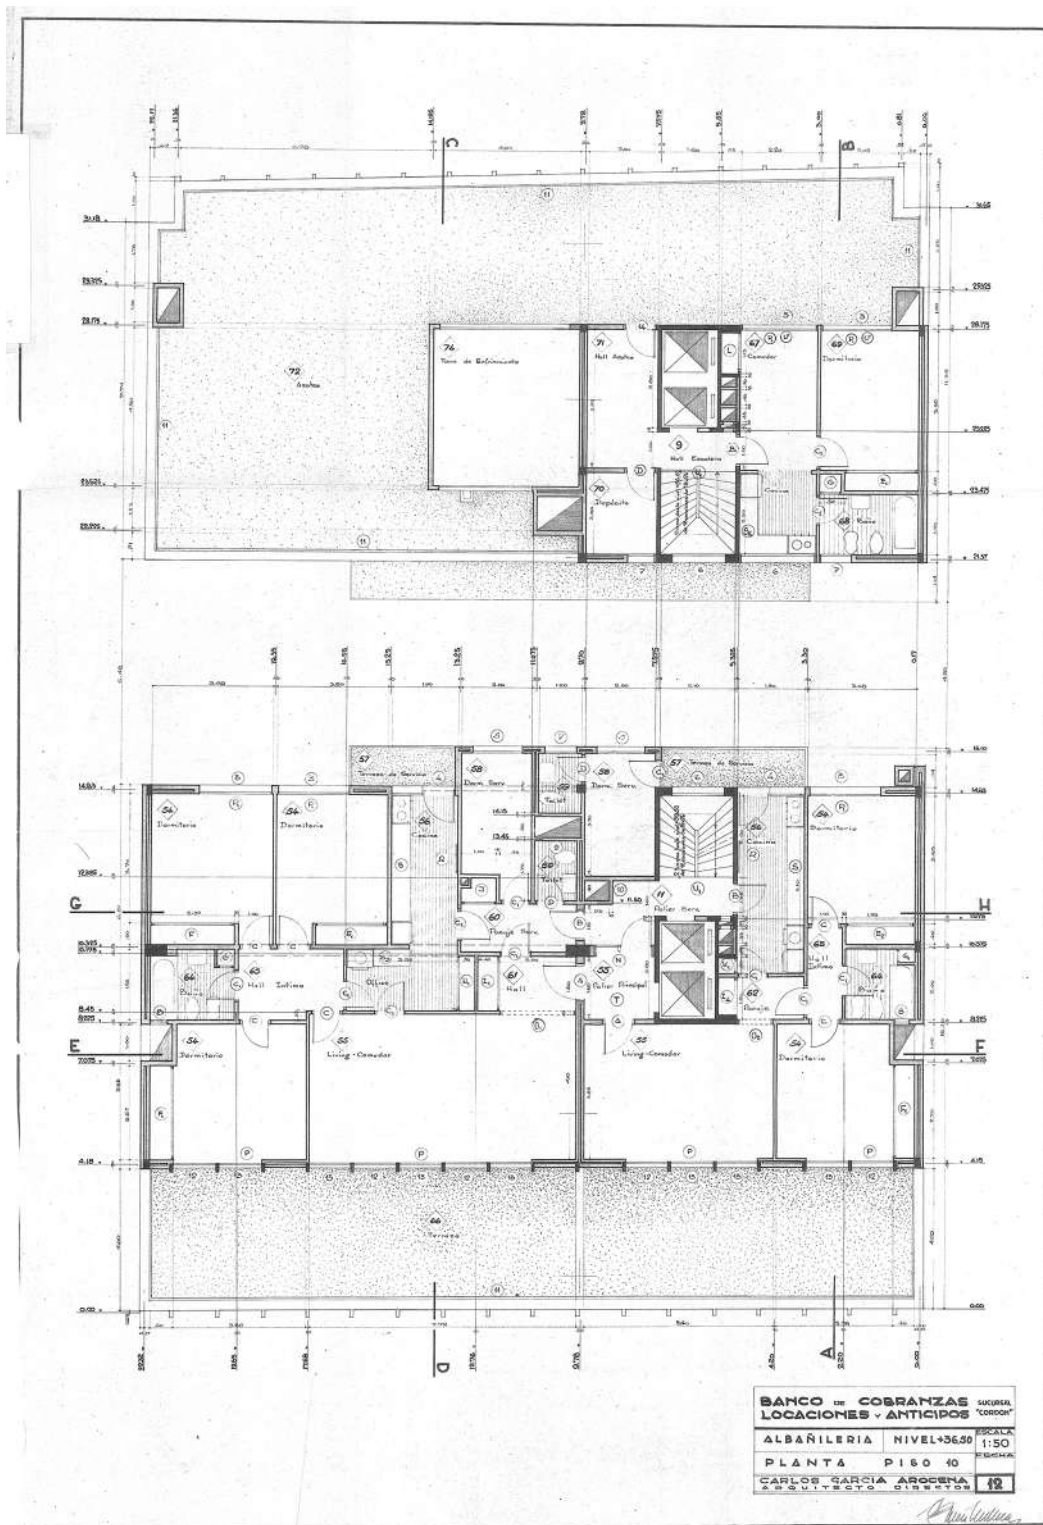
Lámina 12 del proyecto ejecutivo del BCLA: planta del piso 10.
